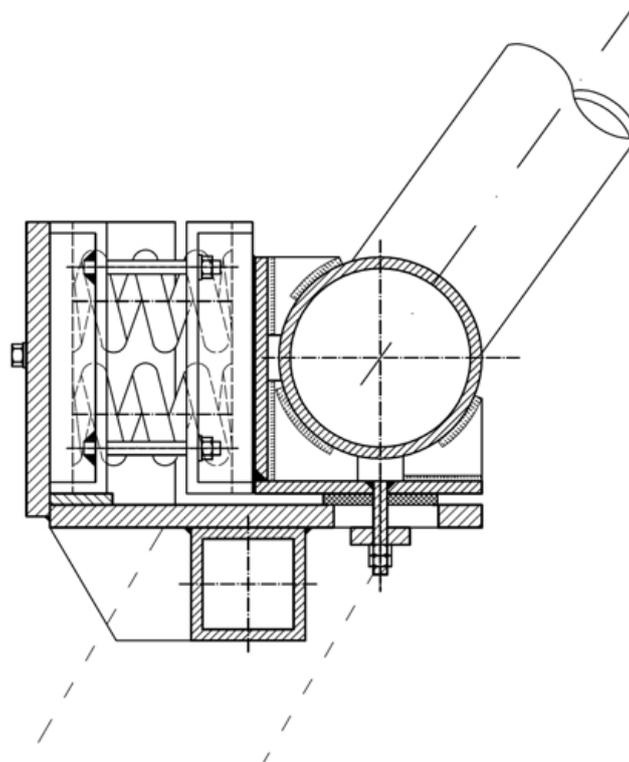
Detail Auflager mit horizontal angeordneten Schraubenfedern
